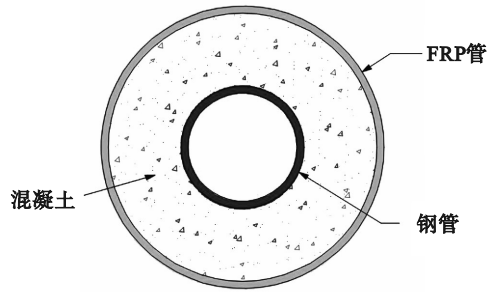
FRP 管-混凝土-钢管组合柱截面示意图
